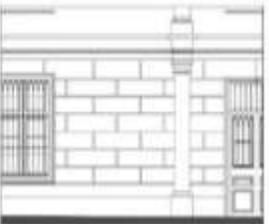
Clasificación de elementos arquitectónicos - Carpintería de Fierro
